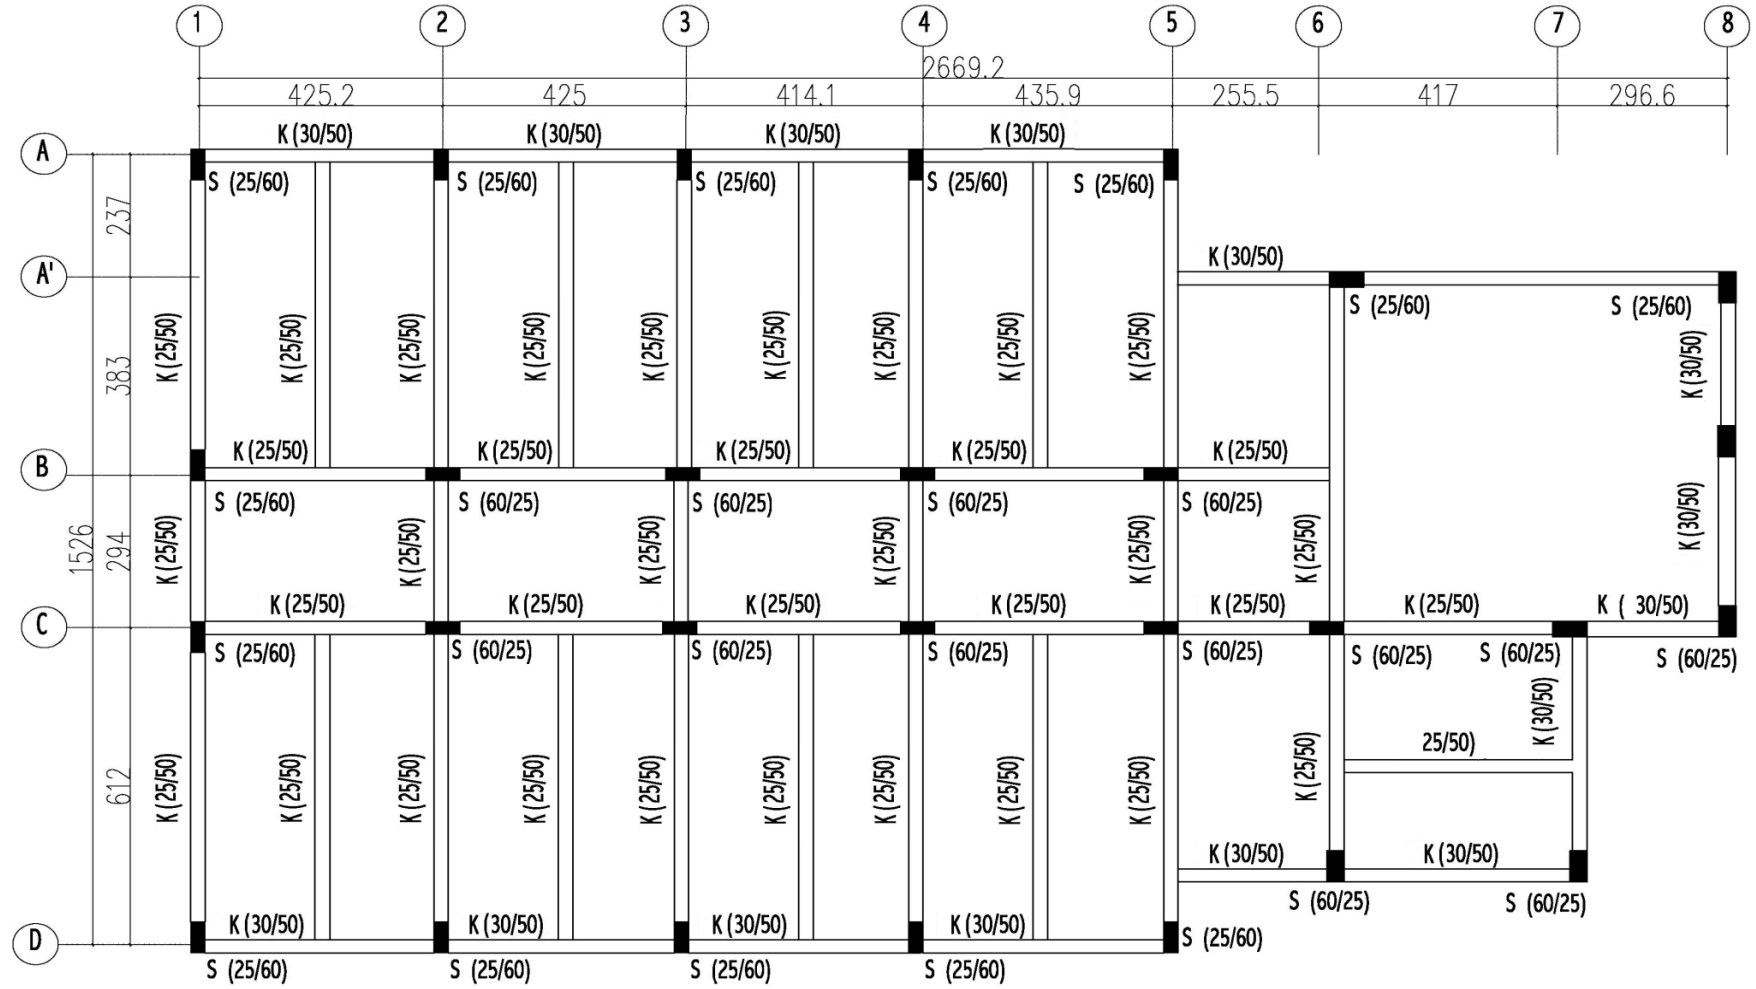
Halıkent Lisesi-A Blok kalıp planı
